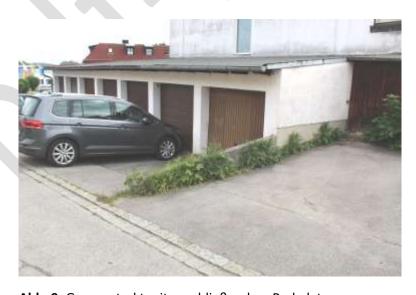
Garagentrakt mit anschließendem Parkplatz
